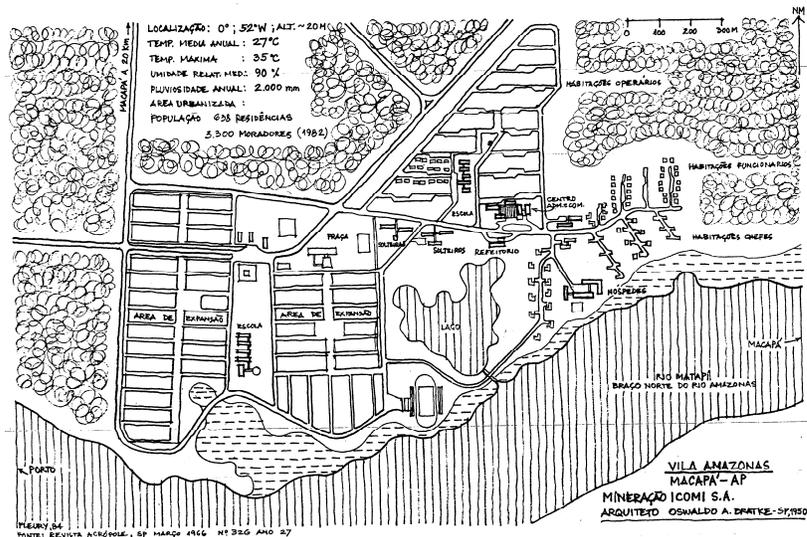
Planta de Urbanização de Vila Amazonas - Amapá.
